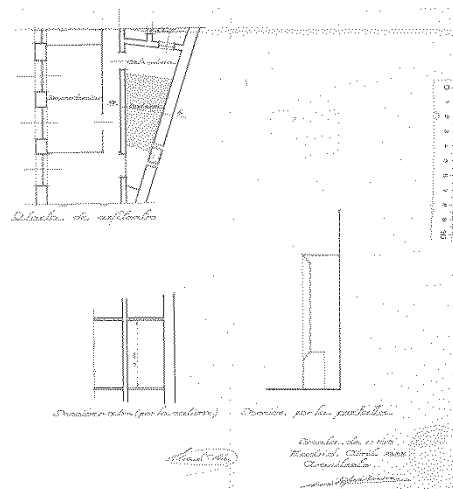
Detalles en planta y sección. AVM 44-152-60\_005.
